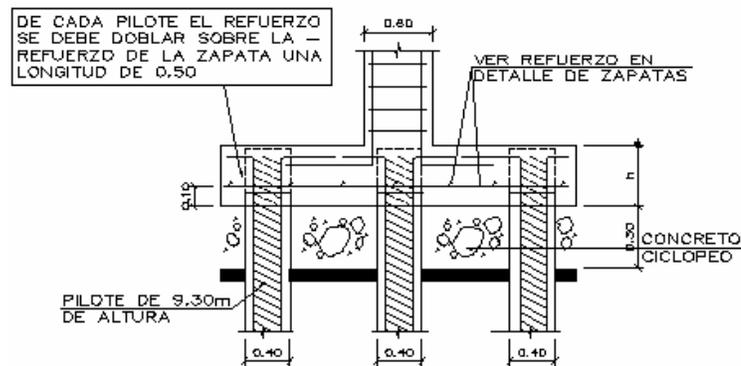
Fundición de concreto ciclópeo bajo la zapata.
